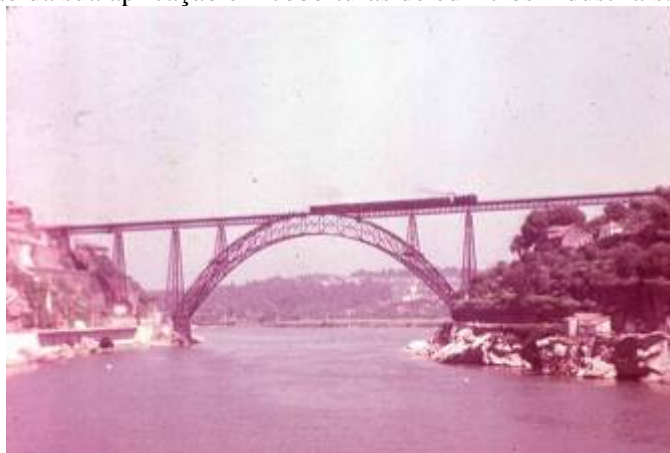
Ponte D. Maria, em estrutura metálica, com um arco de 160 m de corda, construída em 1877 pela empresa G. Eiffel et Cie (concepção de T. Seyrig) [2.1]
